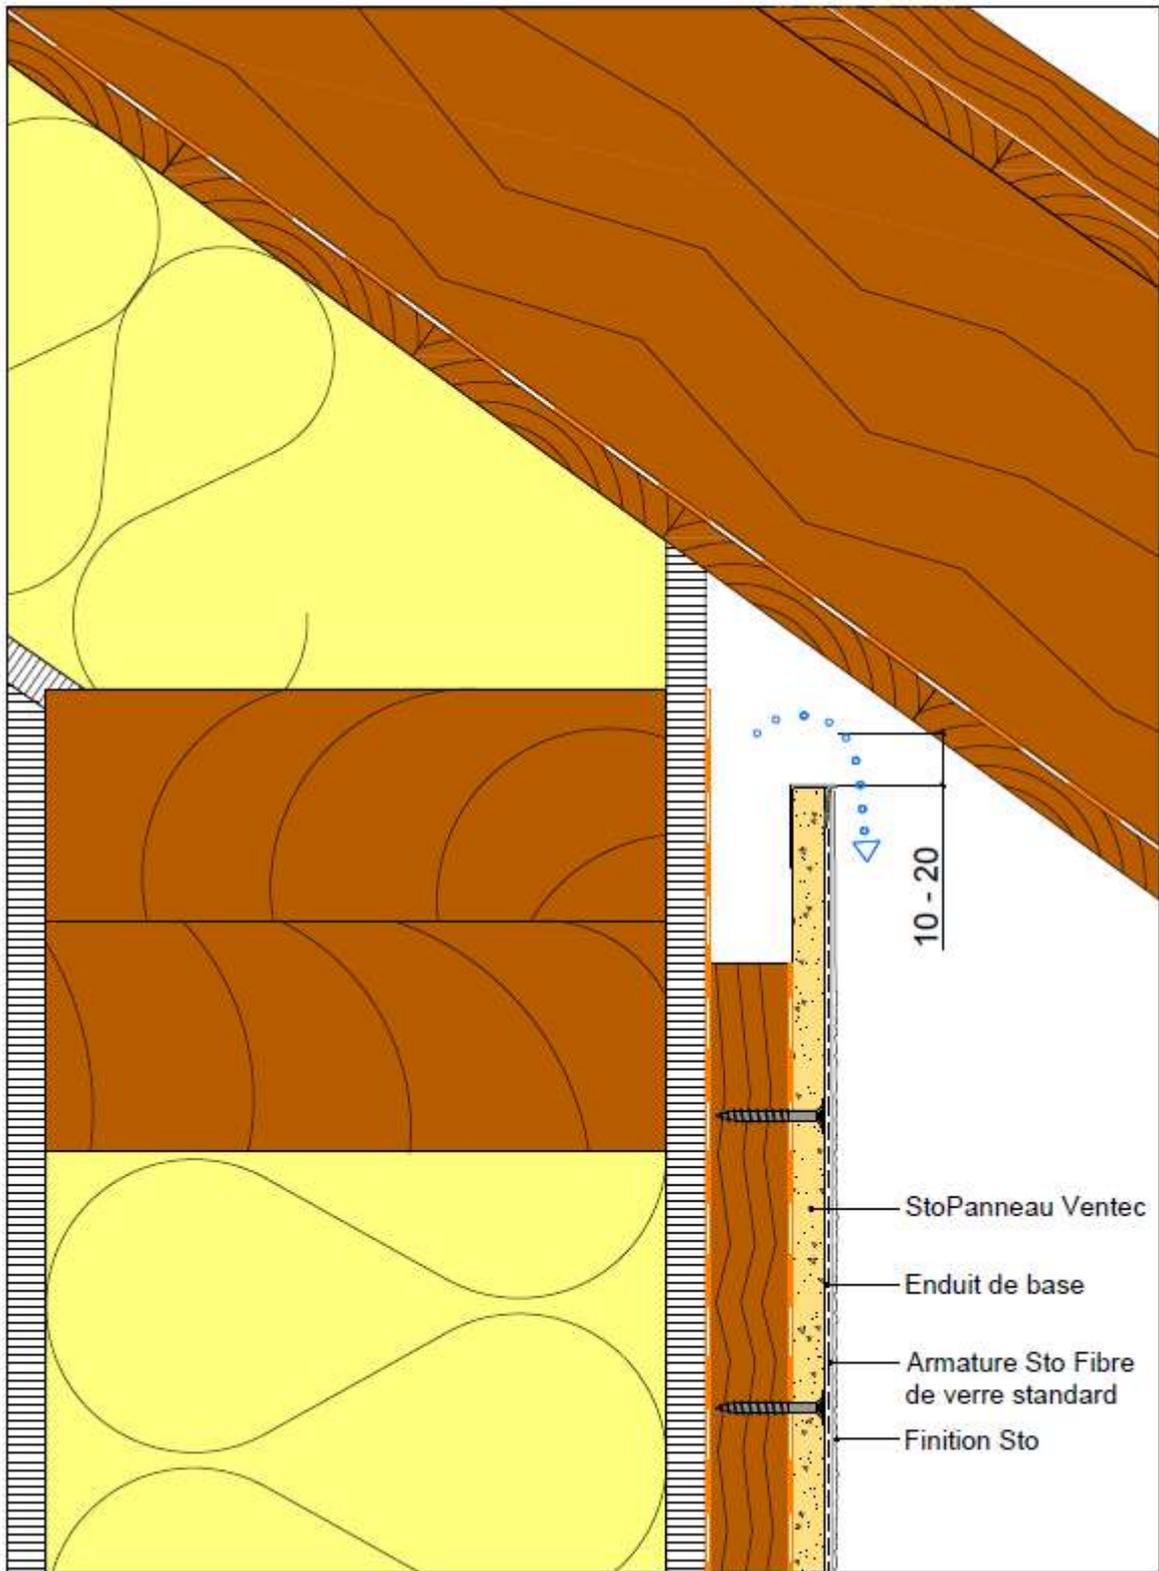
Coupe verticale - Acrotère et sous-face de toiture - Ossatures bois sur COB
